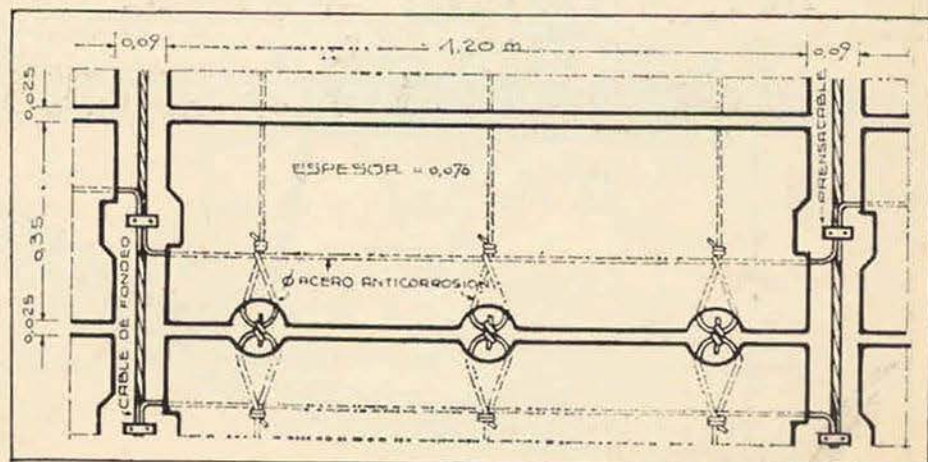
ESTERAS DE HORMIGÓN - DETALLE OBRAS EN EL RÍO MISSISSIPPI
